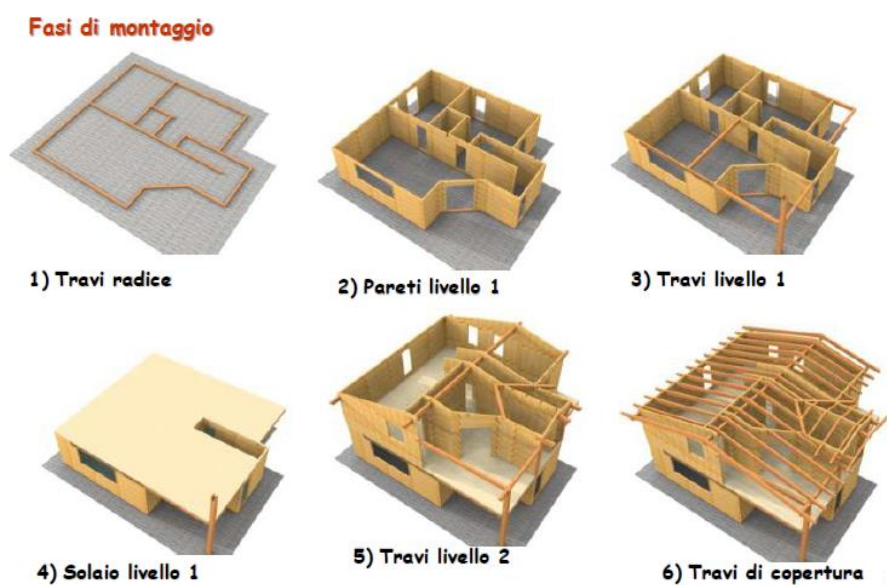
Fasi di montaggio di una casa con pannelli in X-Lam.
